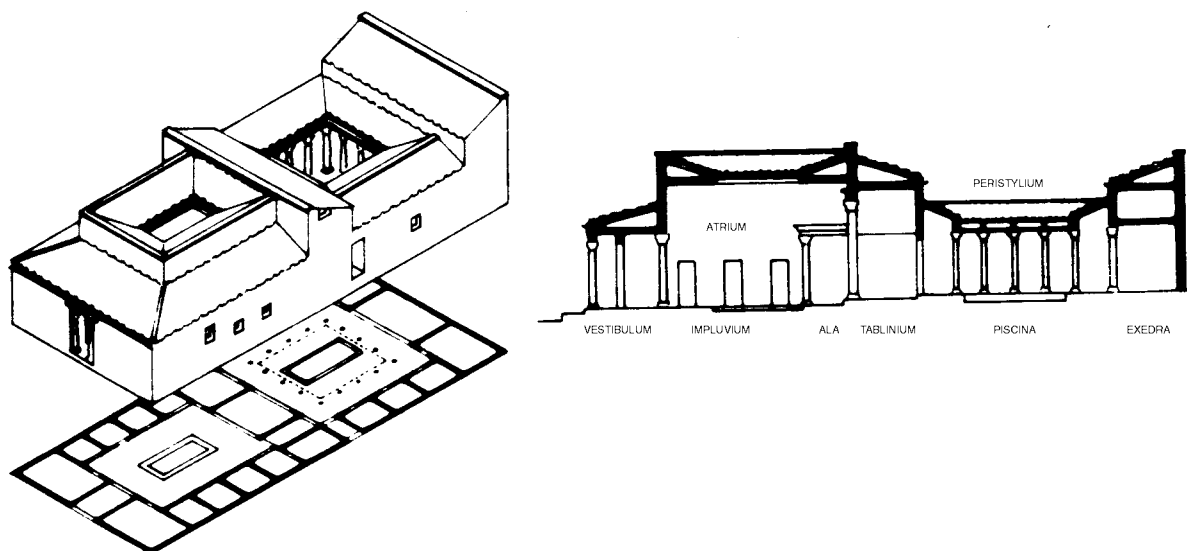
Pianta, ricostruzione prospettica e sezione del tipo di casa ad atrio.
